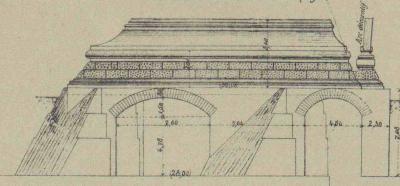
ÉLEVATION SUIVANT ED (Fig 2)
